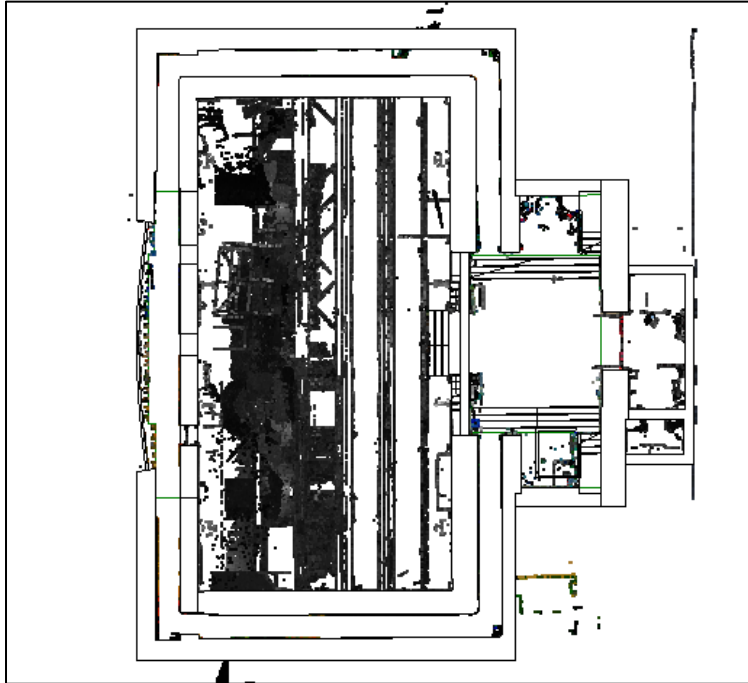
Vista en planta del sótano con la nube de puntos en Revit en el nivel TN-S2
